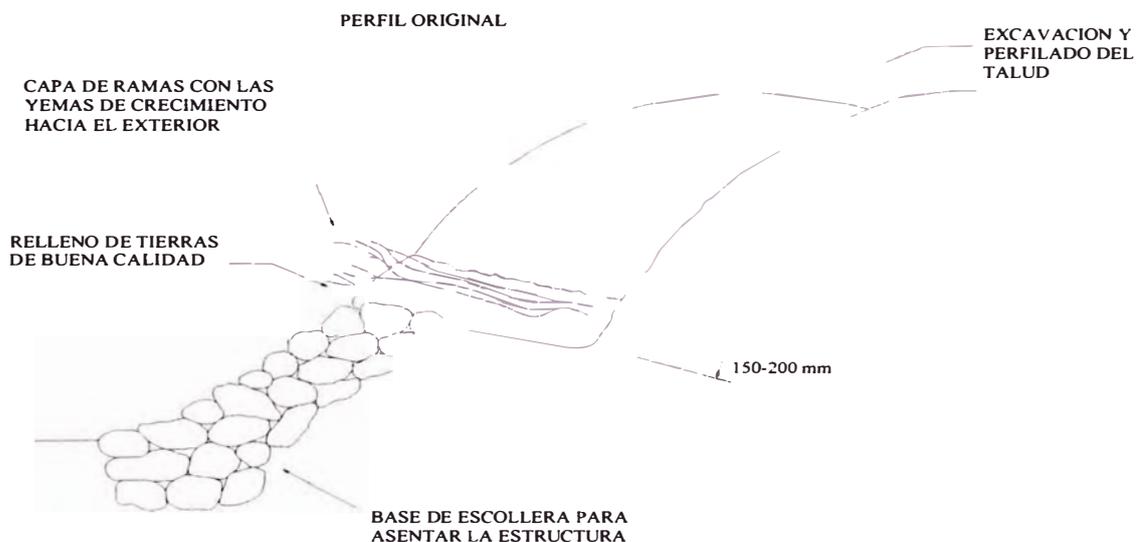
(a): Estructura de tierra reforzada – Proceso Constructivo
